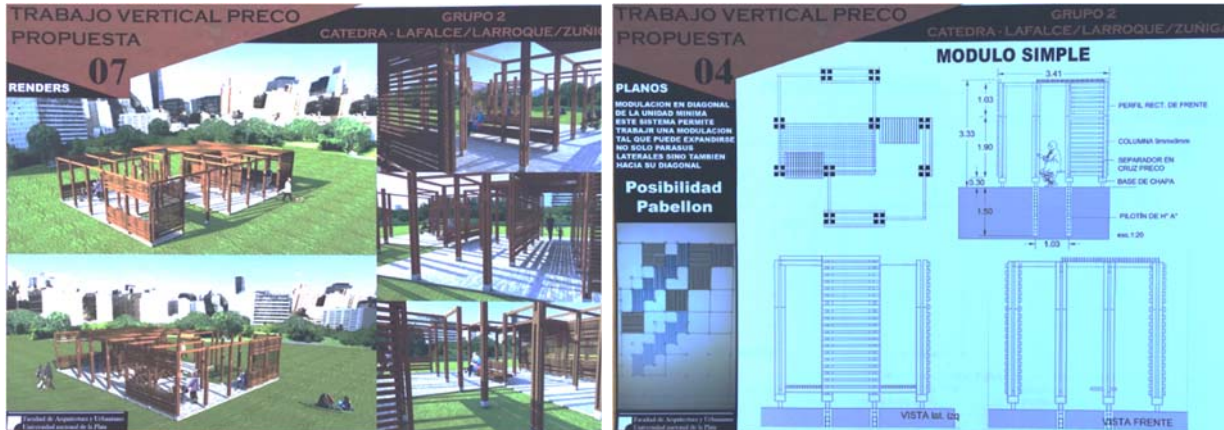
y 9: Construcciones para espacios abiertos, desarrollados por alumnos y docentes de la FAU-UNLP
